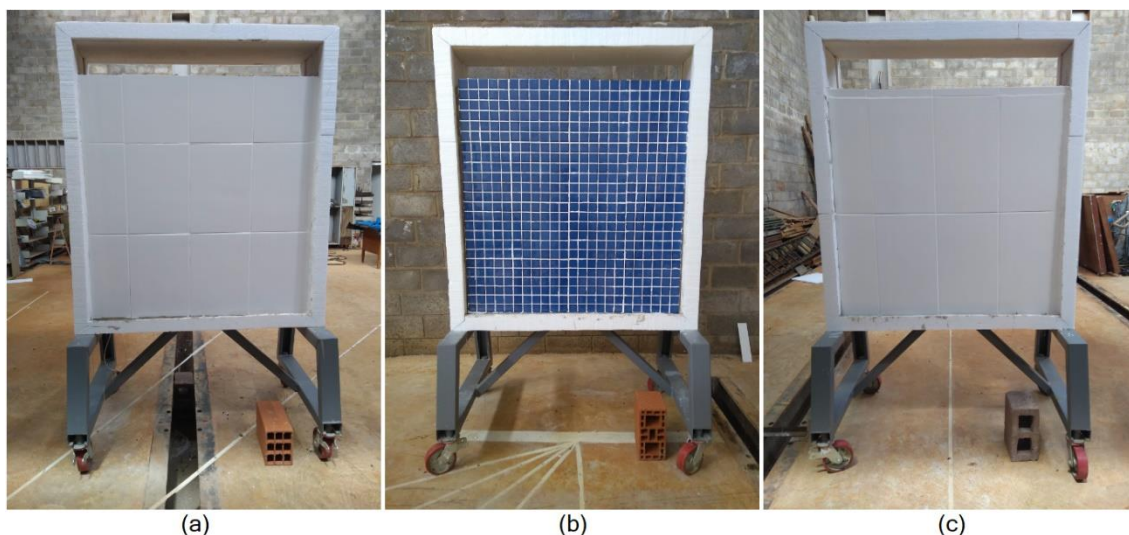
Muretas de ensaio com revestimento cerâmico pronto e acabado.
